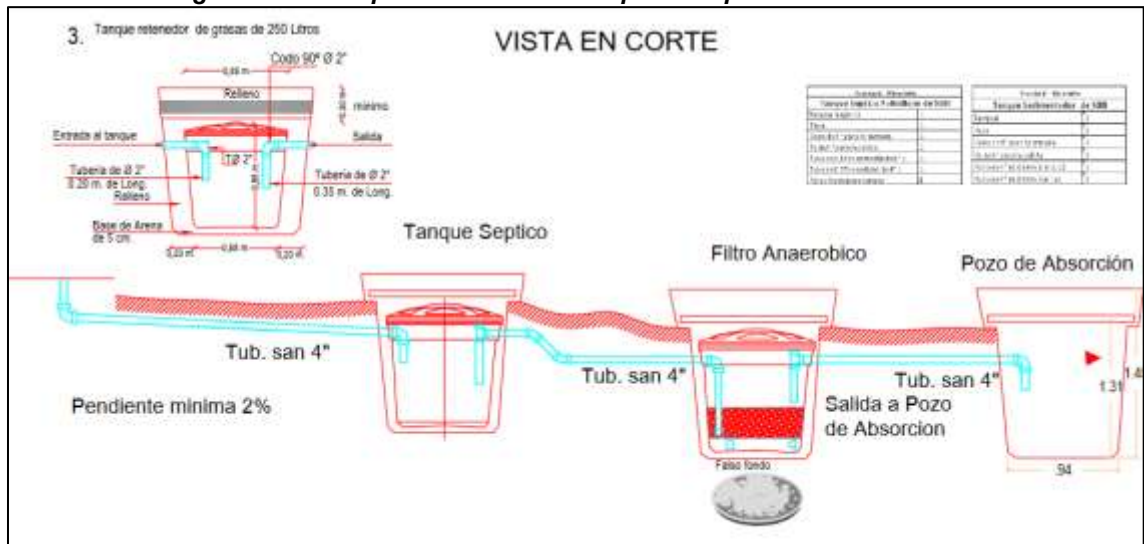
Plano tipo detalle conexiones sanitarias vivienda nueva.
